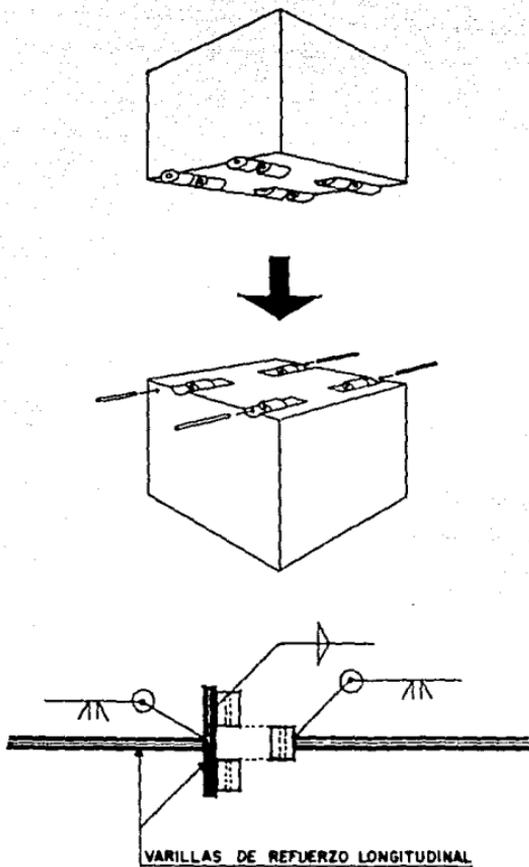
ALTERNATIVA DE CONEXION MECANICA
